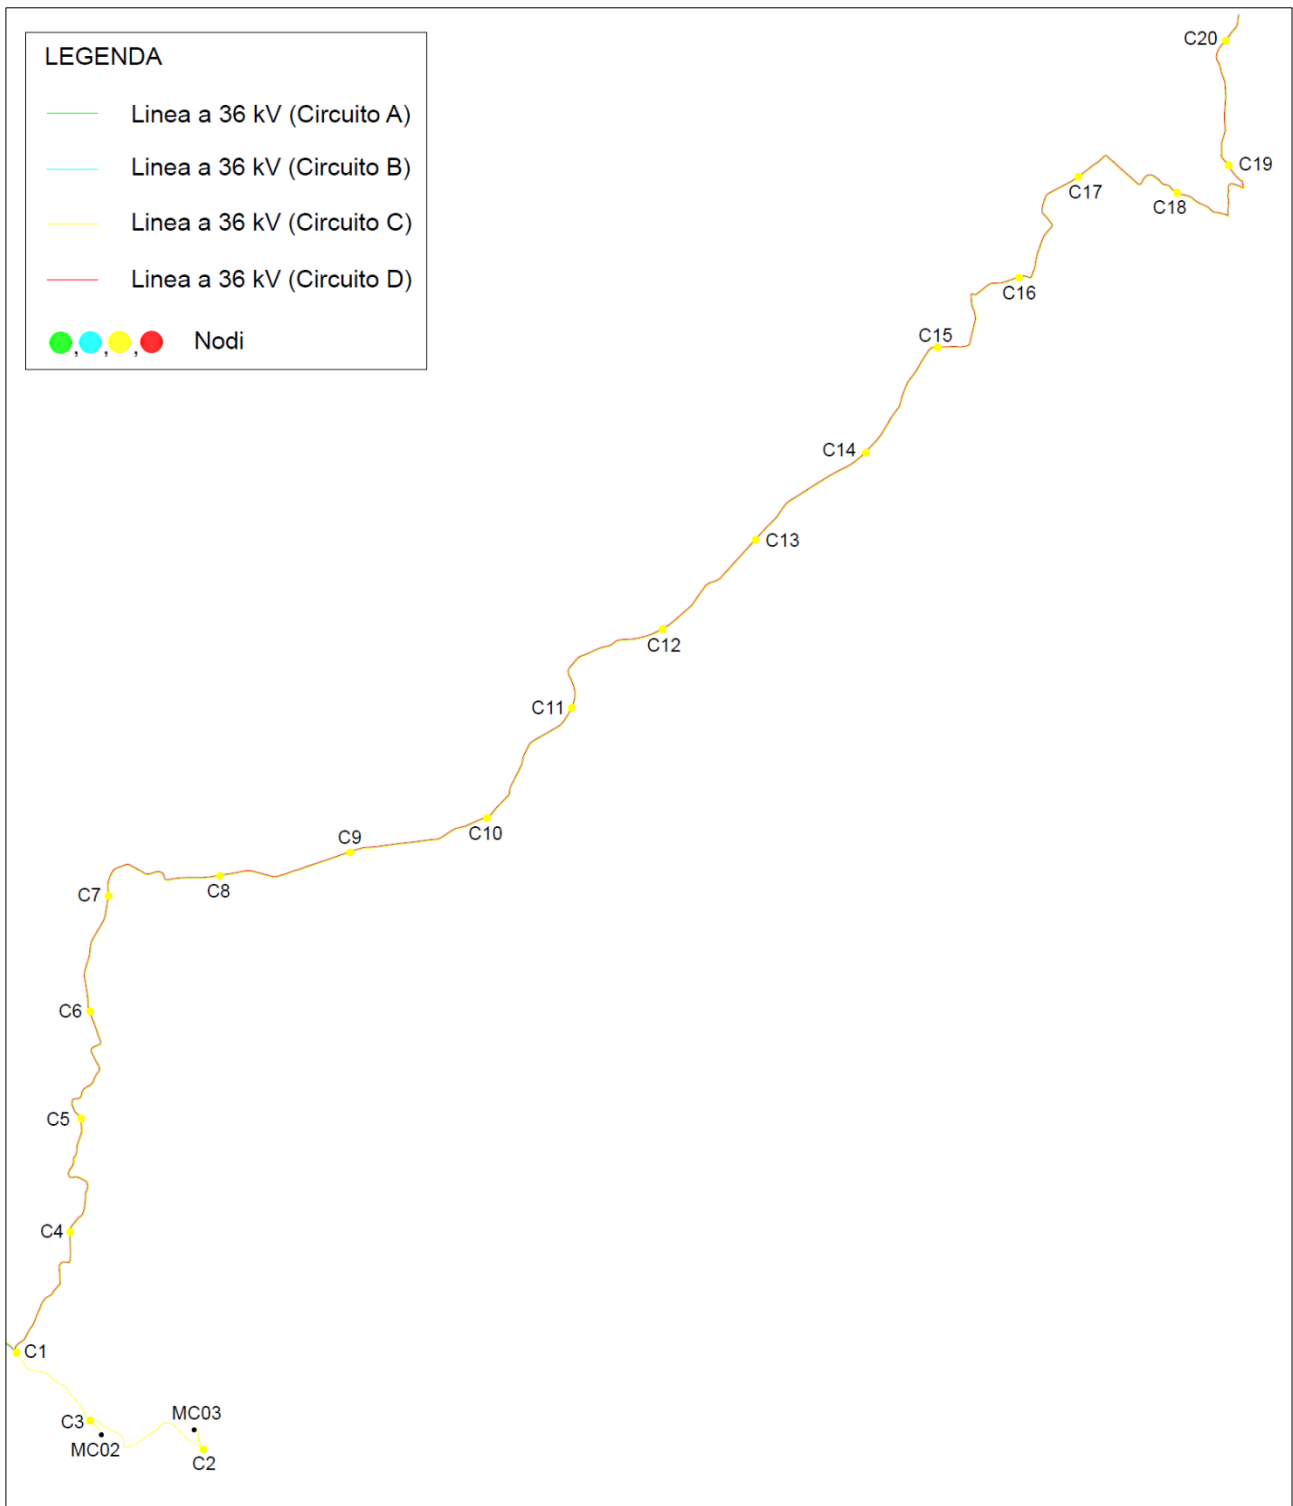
Dettaglio 2 della planimetria di distribuzione linee a 36 kV
